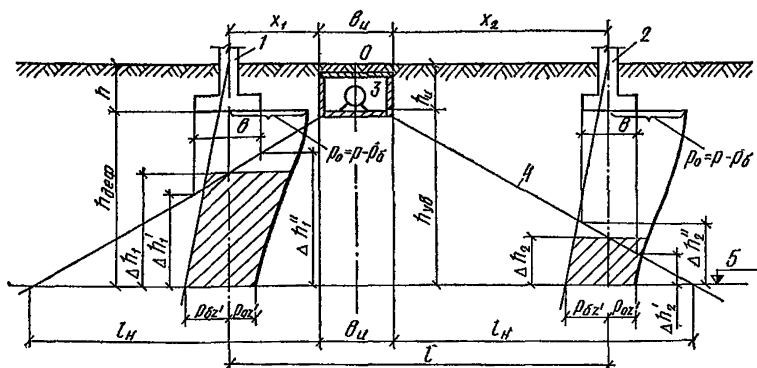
Расчетная схема для определения кренов и разности просадок фундаментов в пределах деформируемой зоны
